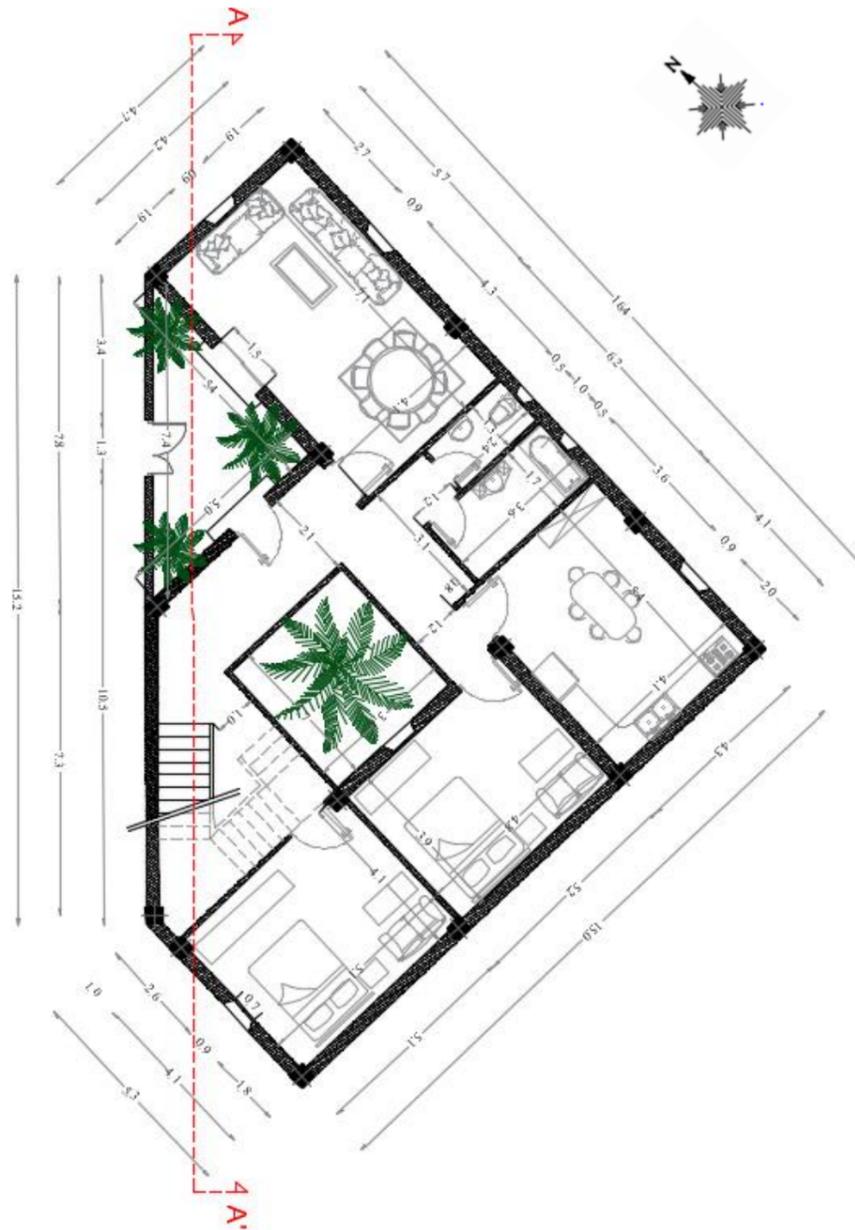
PLAN RDC LOGEMENT TYPE 3.
